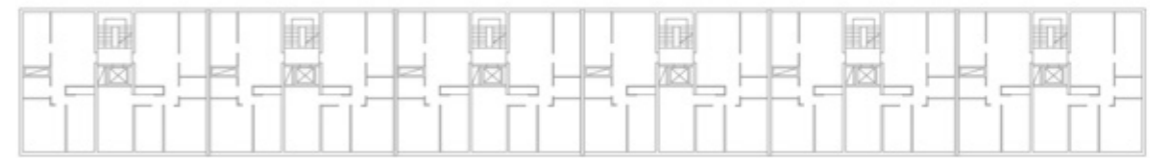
Planta de un superbloque. Re dibujo de producción propia en base a planta tipo de torre publicada en el folleto publicitario.
